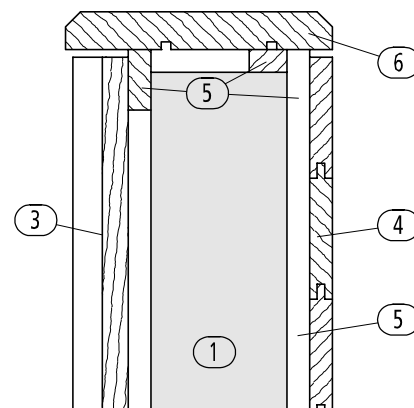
Horizontaler Schnitt – stirnseitige Abdeckung eines Hauptträgers
